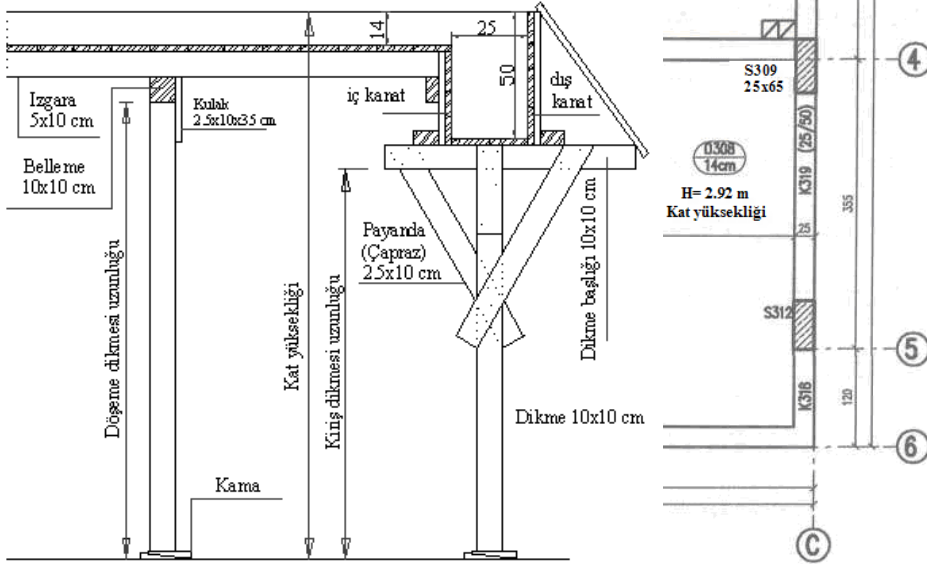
Örnek düşük döşemeli plan ve kesiti
